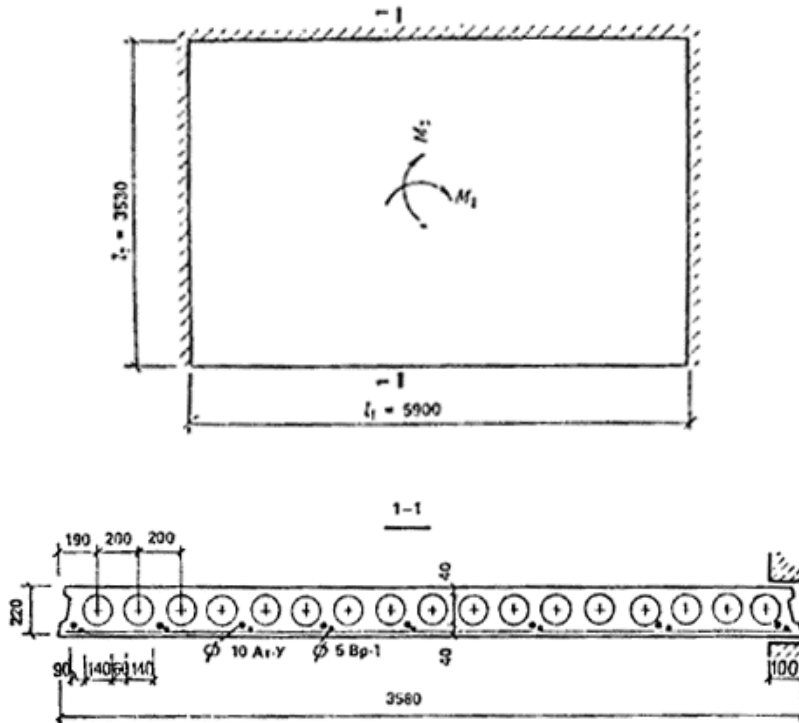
Схема к примеру расчета сборной многопустотной плиты, опертой по трем сторонам
